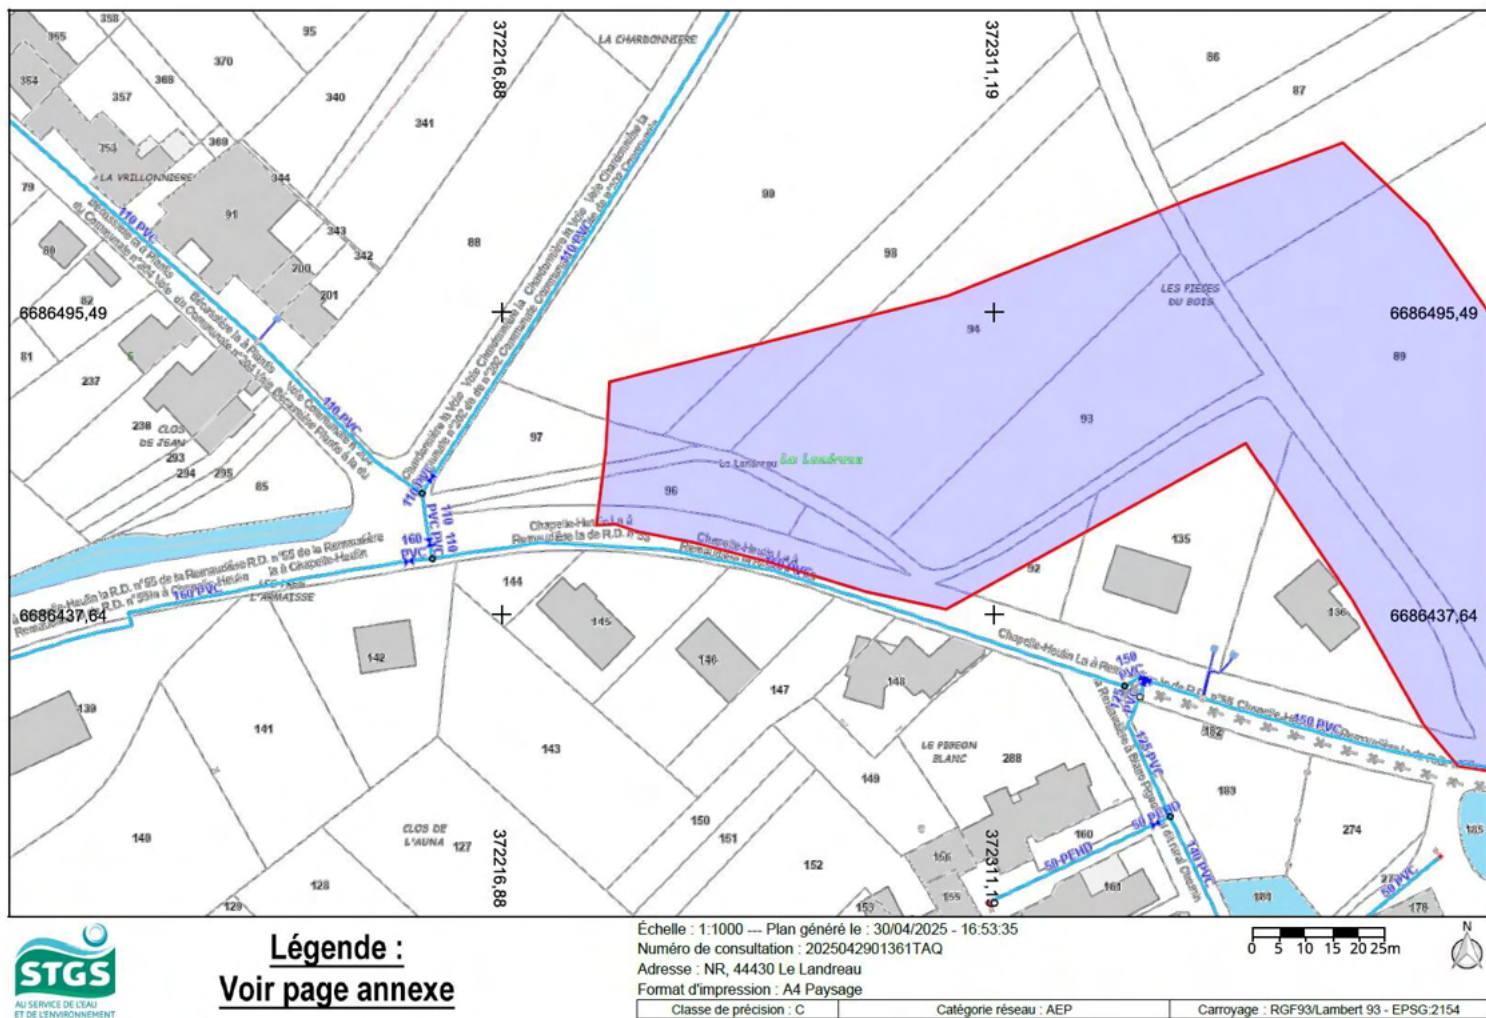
Plan de localisation des canalisations d'eau potable sur l'emprise d'étude (source : STGS)
